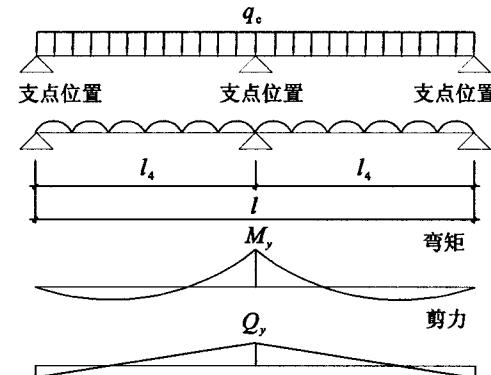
浇筑混凝土时预制剪力墙板内力计算简图
